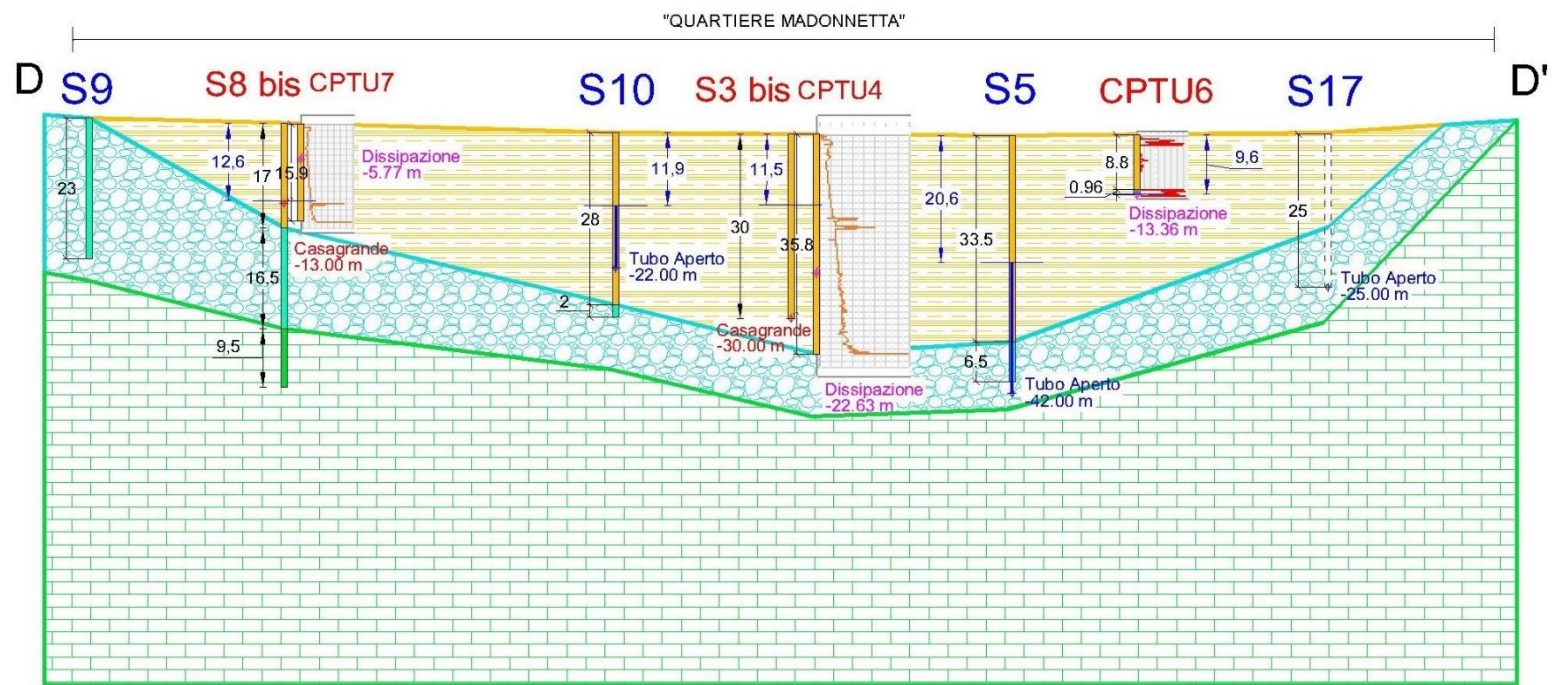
Rappresentazione sezione D-D' con AUTOCAD
